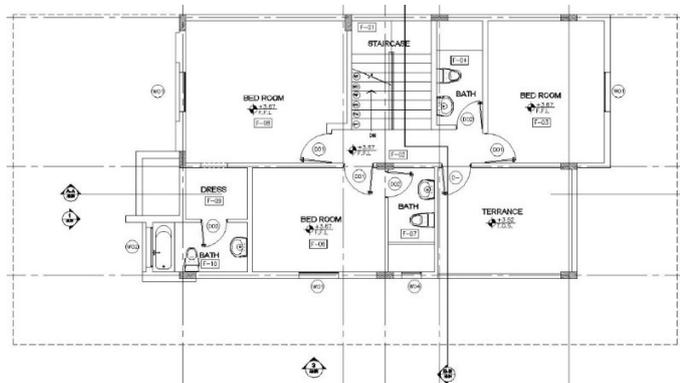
Planta alta arquitectónica. Proyecto Printland.
